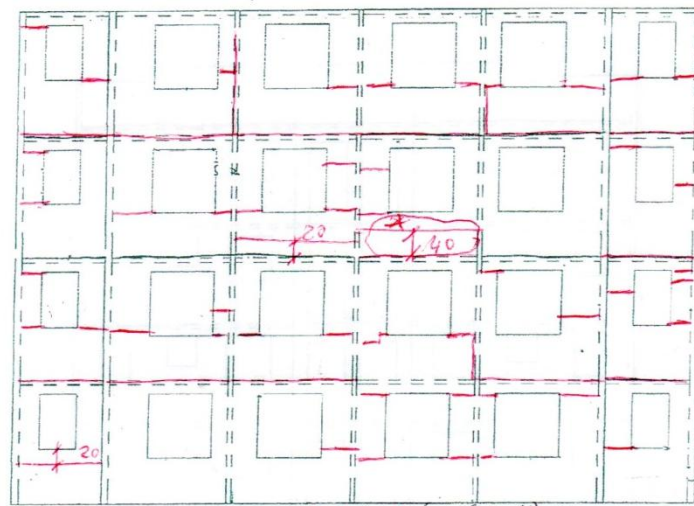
Mapa de Fissuras (próprios autores).
